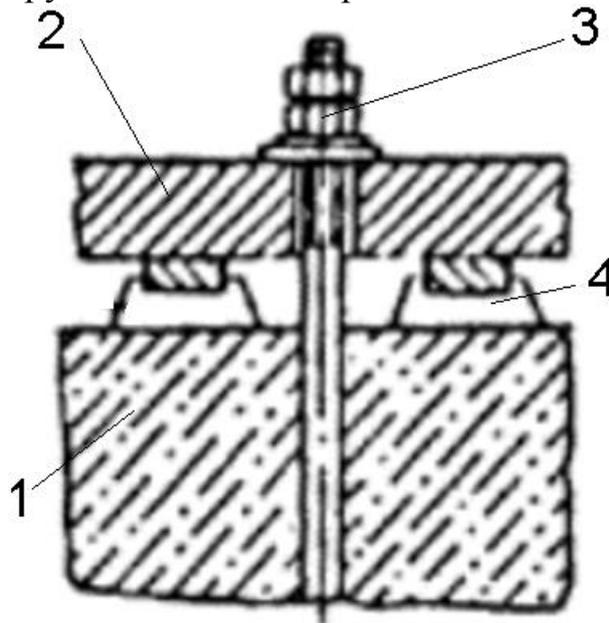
Выверка с помощью подушек: 1 - фундамент, 2 - анкерный болт, 3 - монтируемое оборудование, 4- бетонная подушка.
